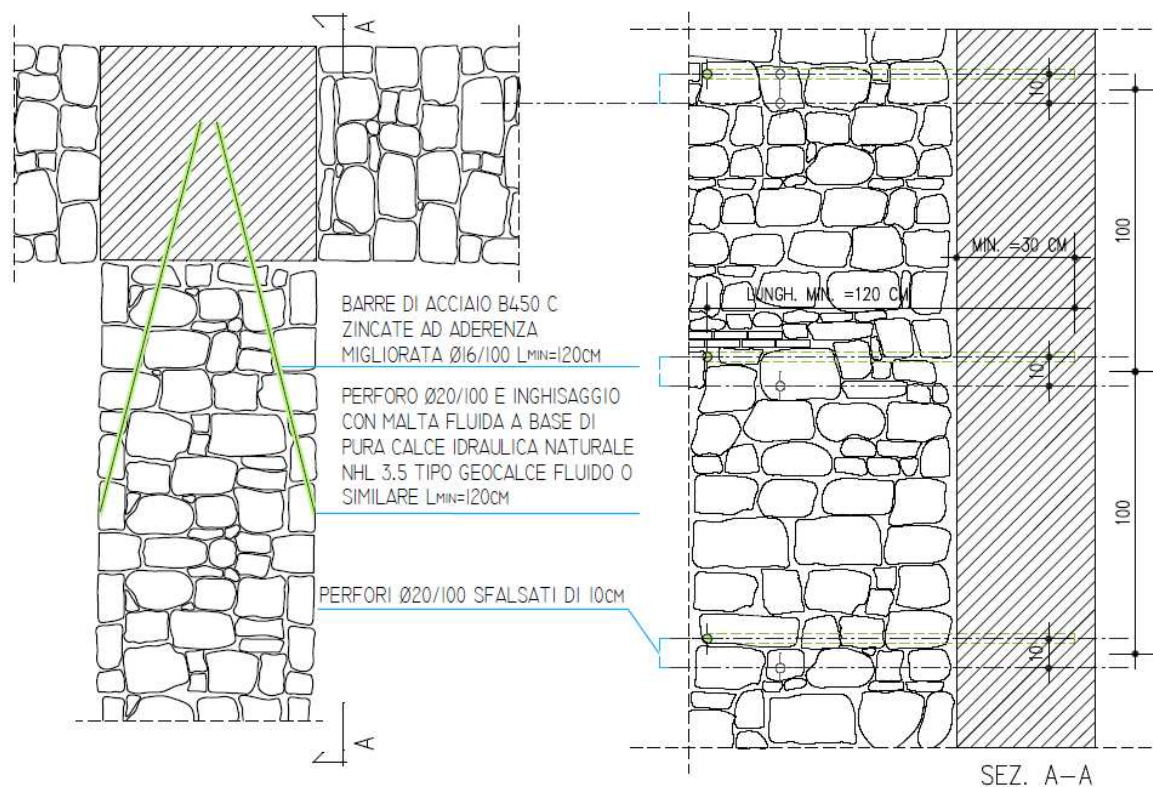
rinforzo a flessione e a taglio con tessuto in fibra di acciaio: sez.B-B Interventi per garantire la continuità materica e strutturale dei cantonali
